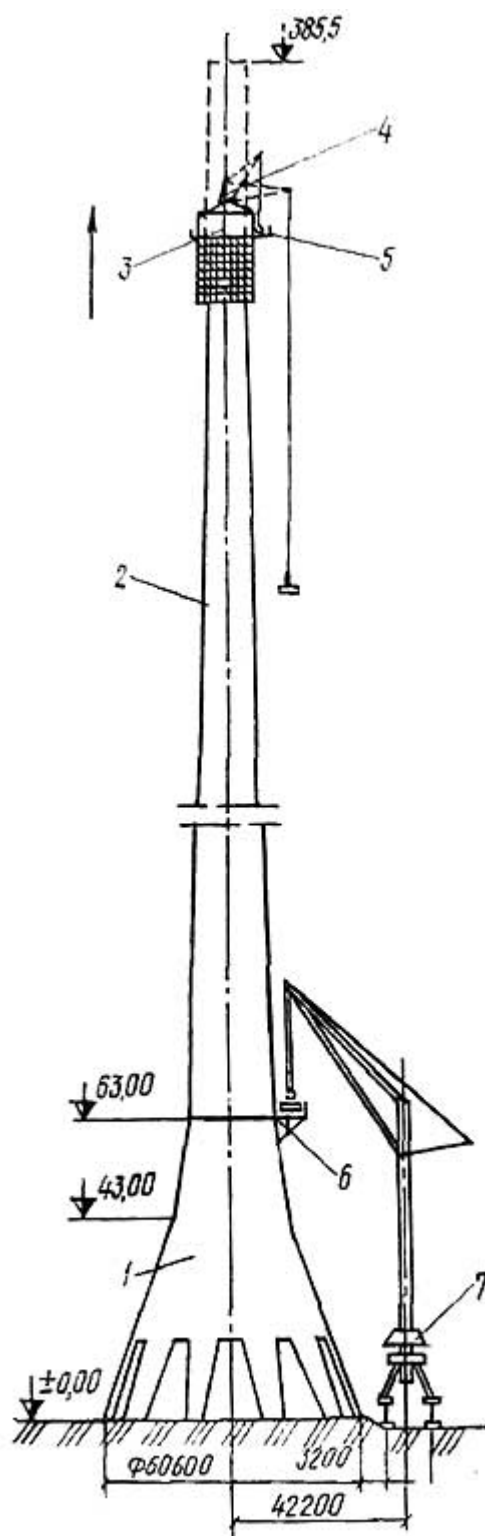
Схема возведения телевизионной башни в Останкино с помощью механизированного опалубочного агрегата: 1 - опорная часть башни; 8 - ствол башни; 3 - опалубочный агрегат; 4 - легкий кран; 5 - приемная площадка; 6 - перегрузочная площадка; 7 - башенный кран
